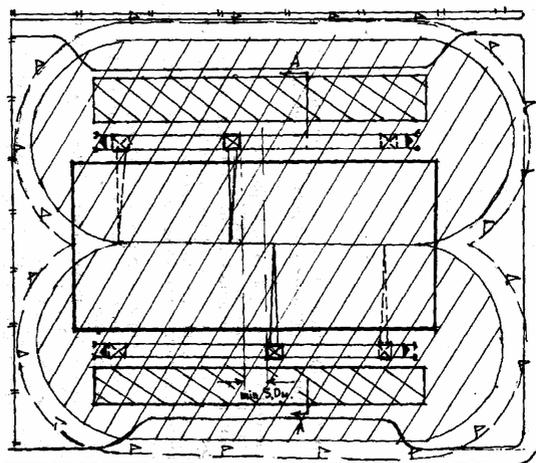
Схема решения стройгенплана при совместной работе двух кранов
